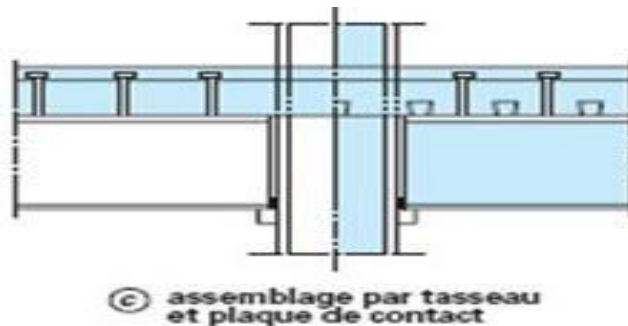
Assemblage par tasseau et plaque de contact [2]
